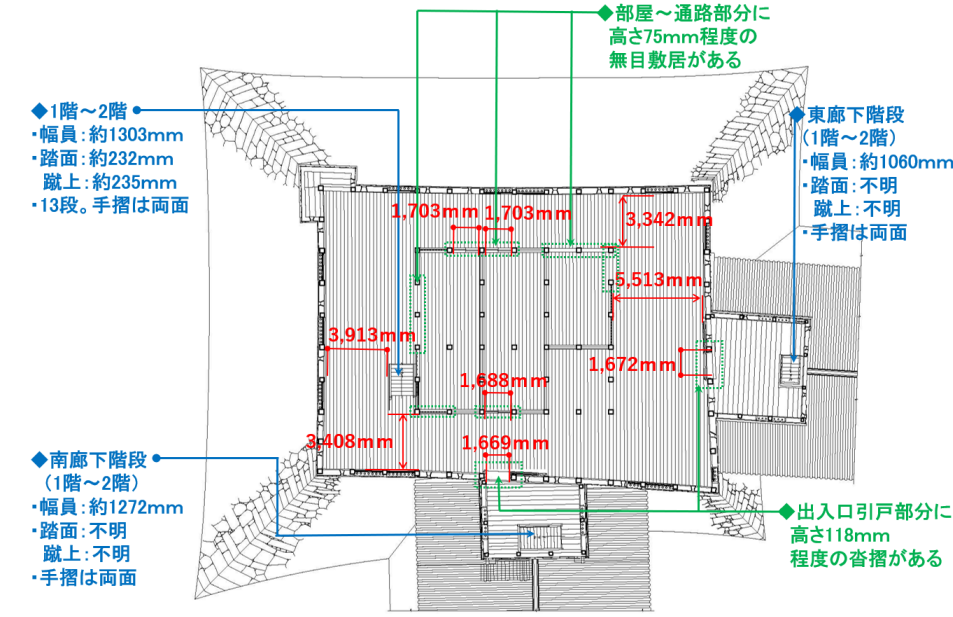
天守 1 階平面図及び東廊下・南廊下 2 階平面図（復元原案）
